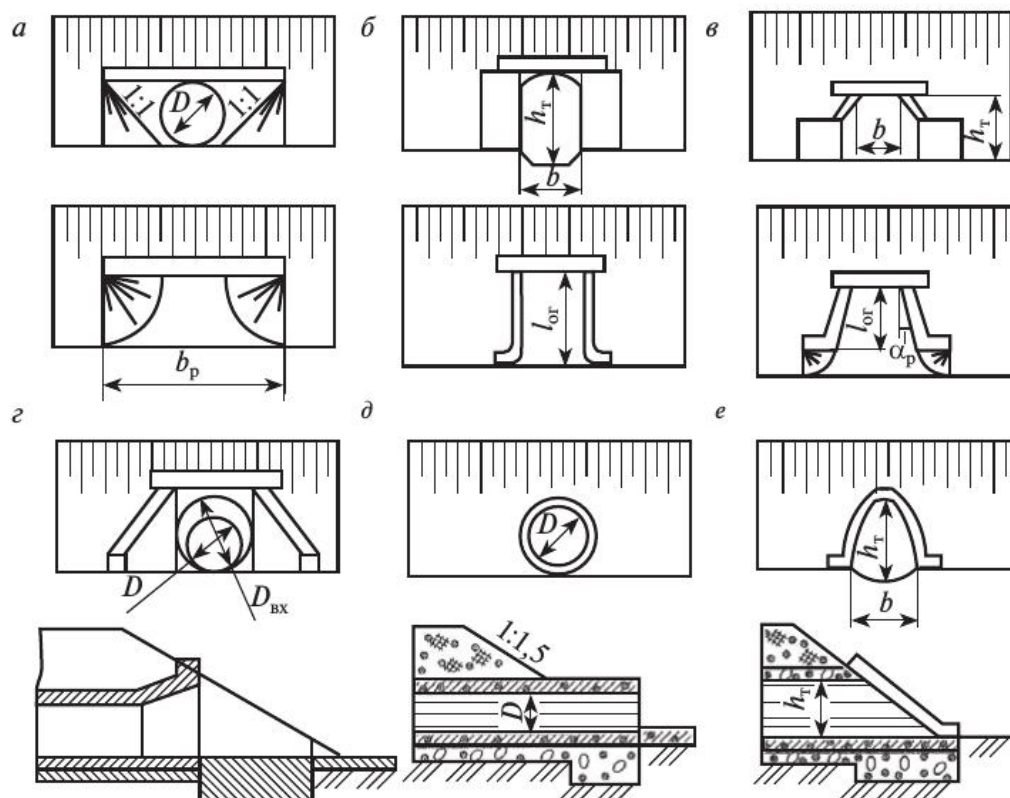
Формы и типы оголовков водопропускных труб (а–в — фасад и план; г–е — фасад и продольный разрез): а — круглая с порталным оголовком; б — с вертикальными стенками и коридорным оголовком; в — прямоугольная с раструбным оголовком с обратными стенками; г — круглая с коническим звеном и раструбным оголовком; д — круглая безоголовочная; е — овоидальная с воротниковым оголовком
